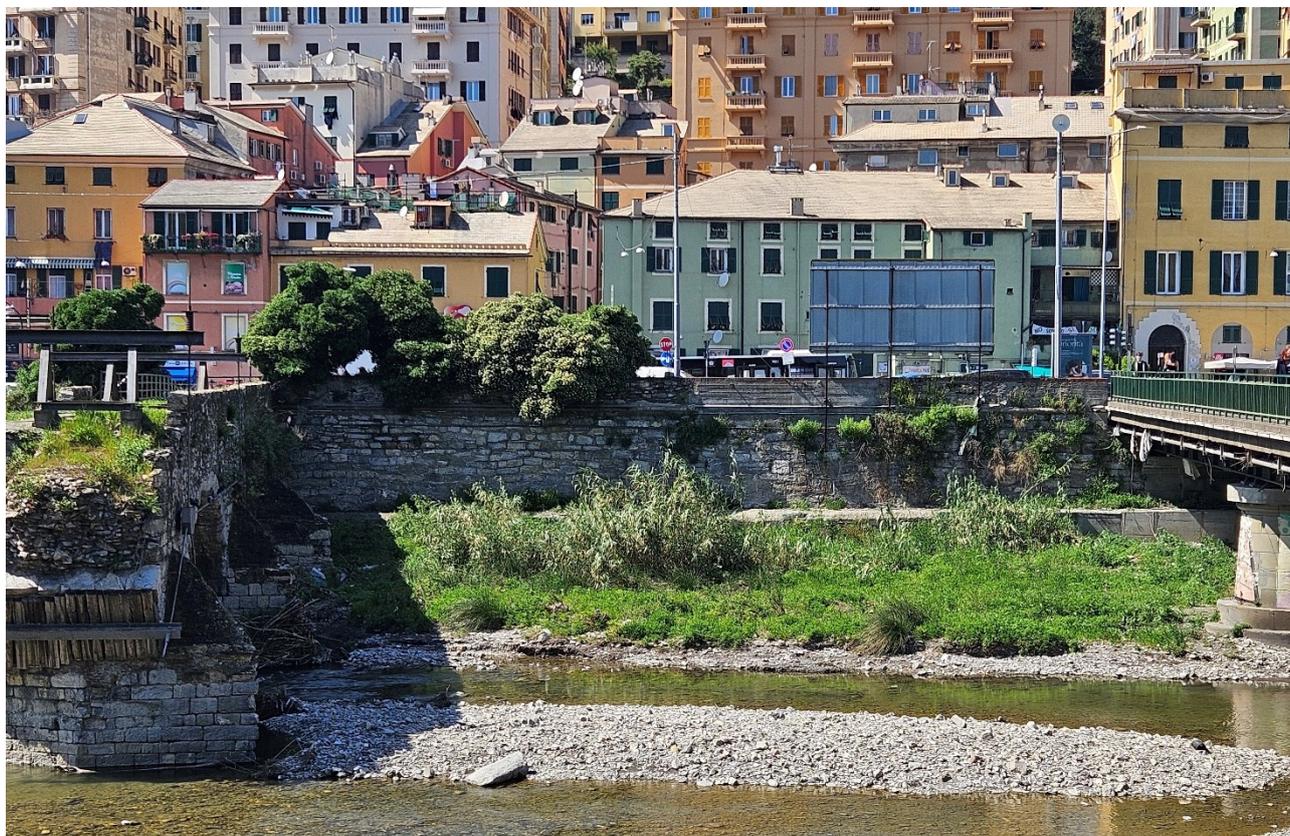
Argine in pietra con parapetto in cemento armato nel tratto tra Ponte Castelfidardo e ponte Sant’Agata
